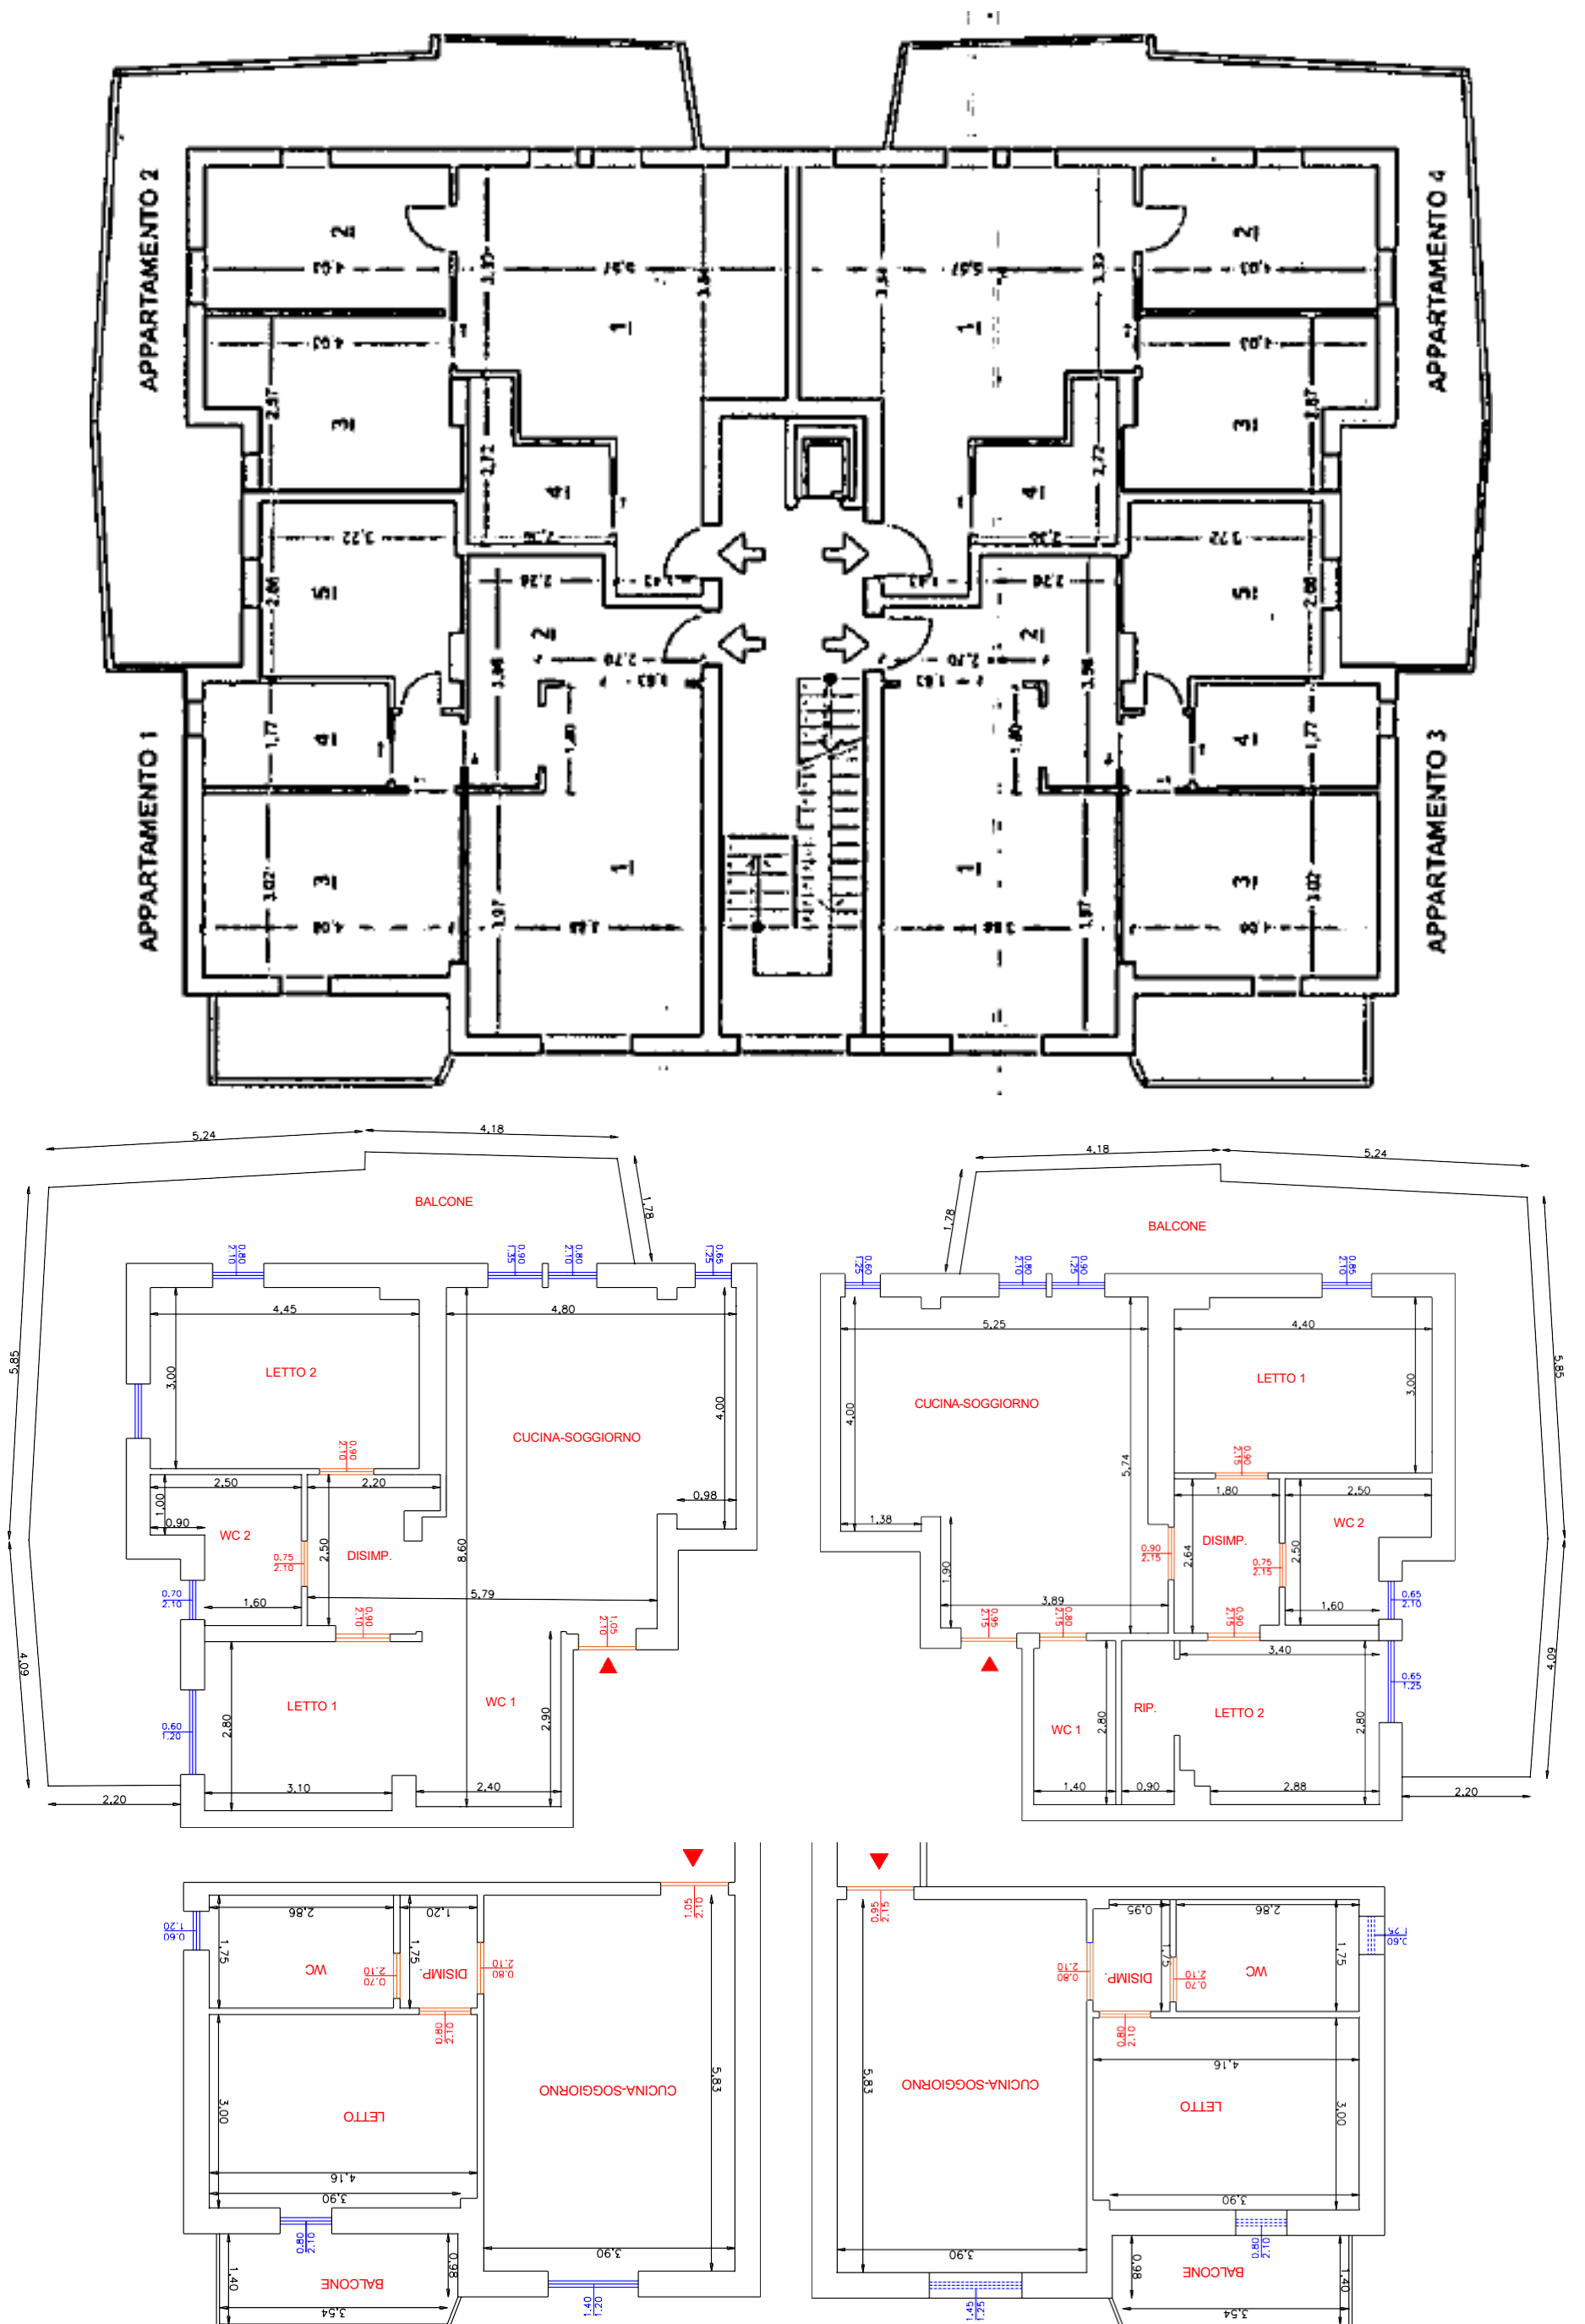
Raffronto planimetrie progettuali della CILA protocollo n. 37264 del 21/04/2020 (sopra) e planimetrie d'arredo (sotto) - PIANO SECONDO
